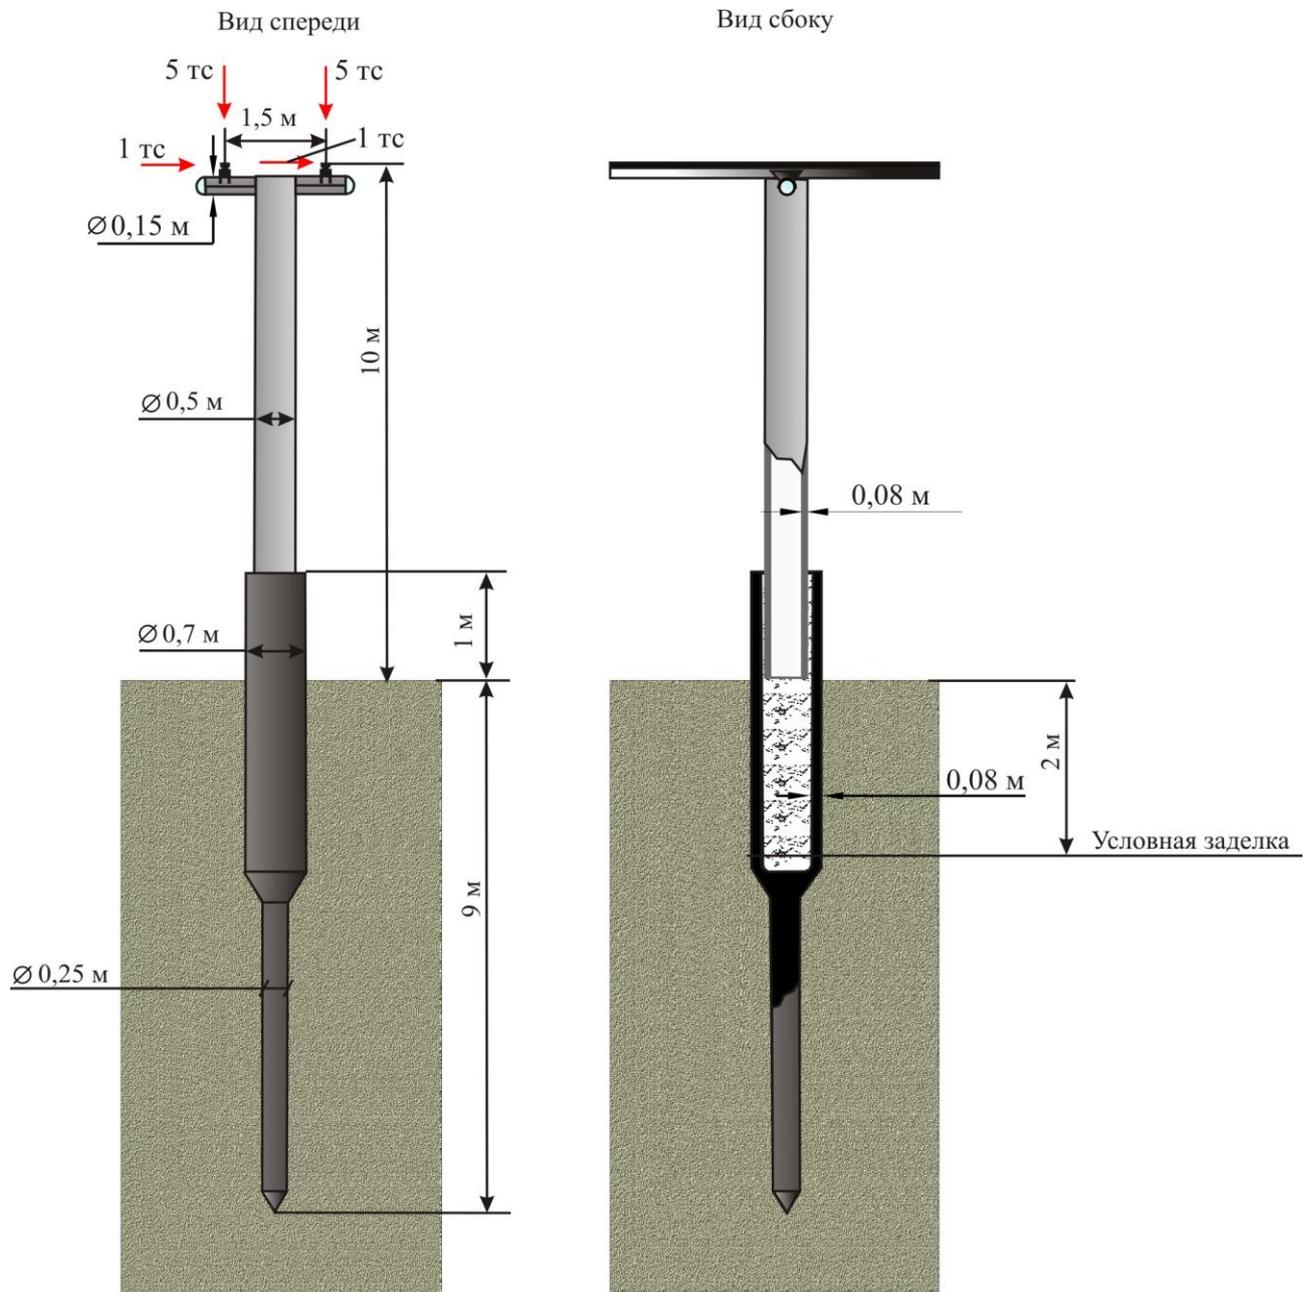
Габаритные размеры промежуточной железобетонной поддерживающей опоры
